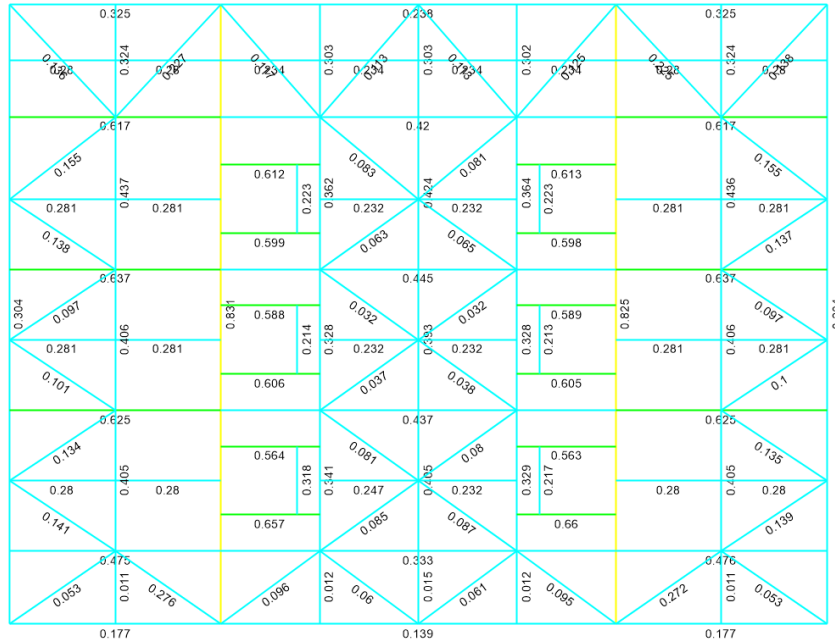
Factores de utilización planta cuarto nivel para cargas de diseño LRFD.
